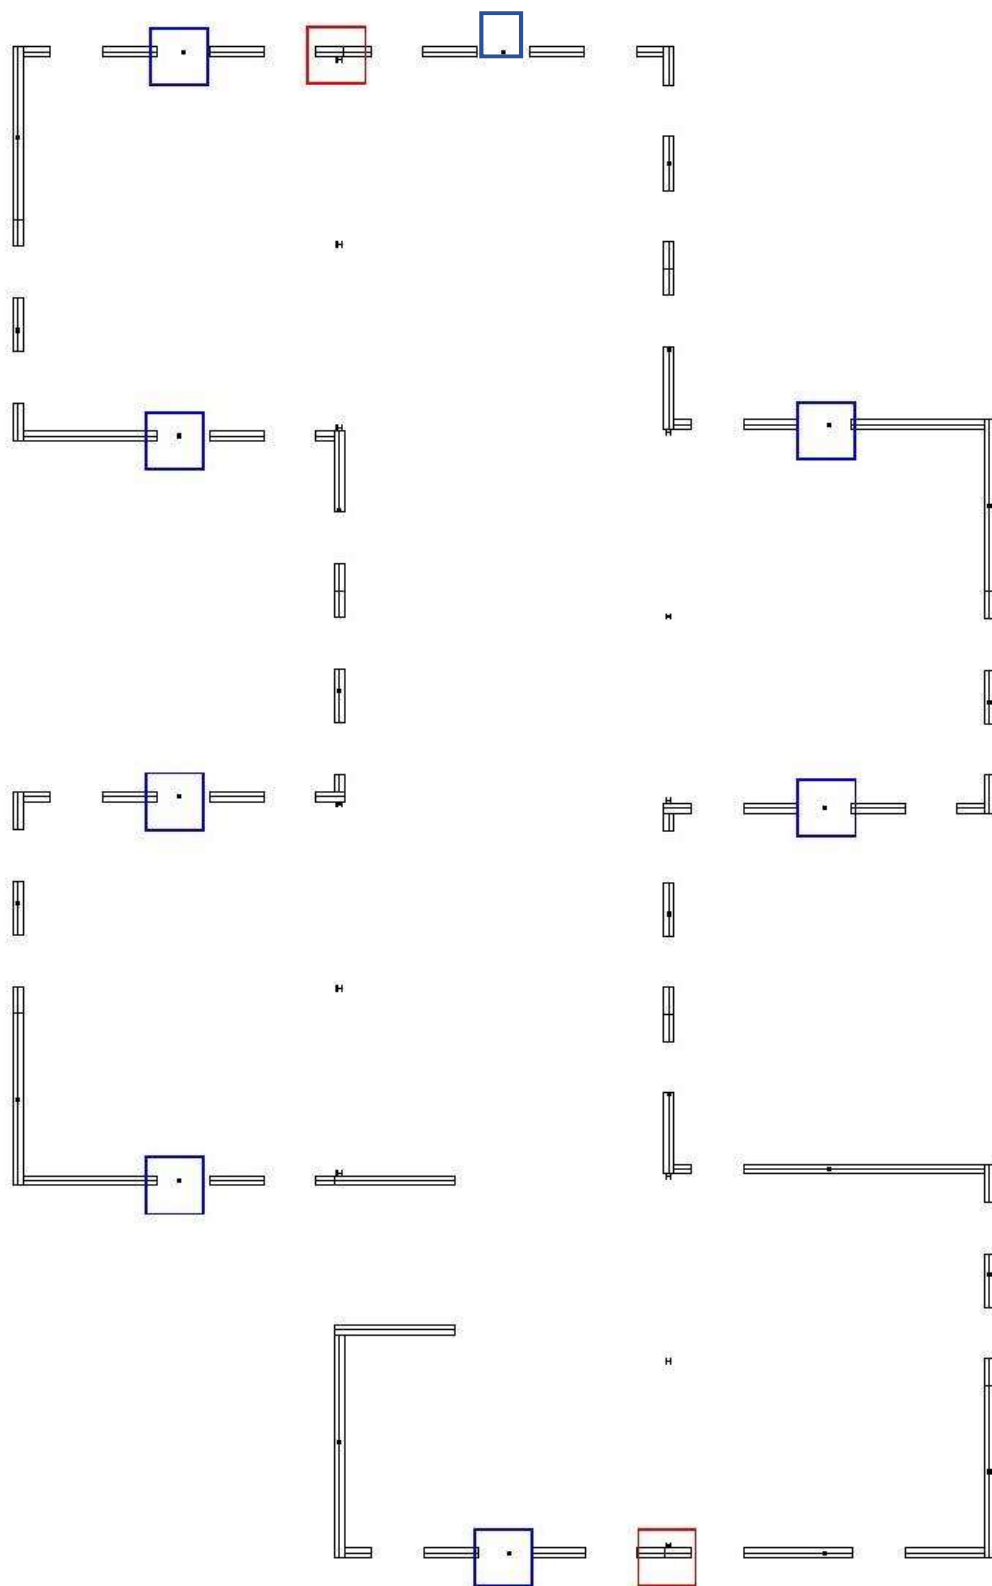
Pianta dell'edificio: evidenziati in blu e in rosso rispettivamente i montanti scatolari e gli HE120
